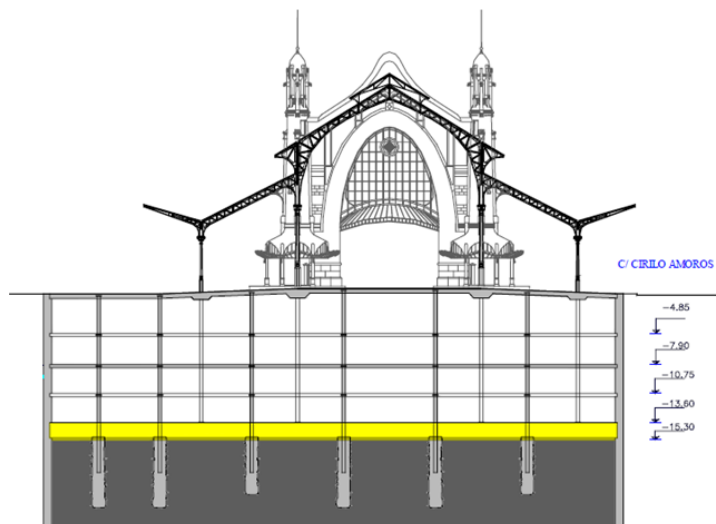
Estructura de las nuevas plantas del Mercado Colón formada por muros pantalla, losa de cimentación, pilares-pilote y pilotaje que rodea las portadas (Martínez Díaz, et al., 2004).
